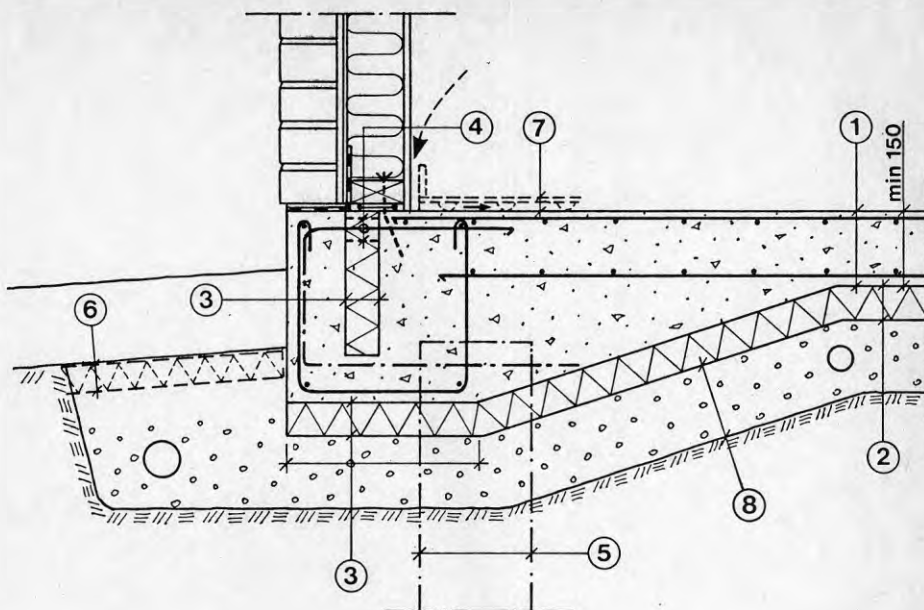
Grundplatta med värmeisolering av lättklinker och med tät betongplatta.
